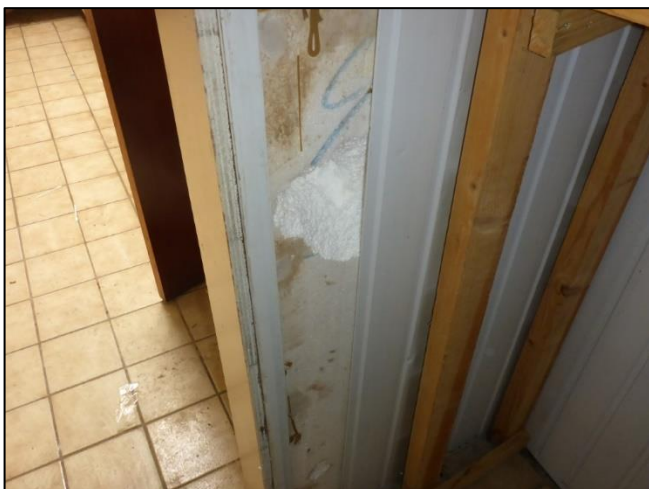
Koelcel: Wandafwerking (Niet asbestverdacht)
